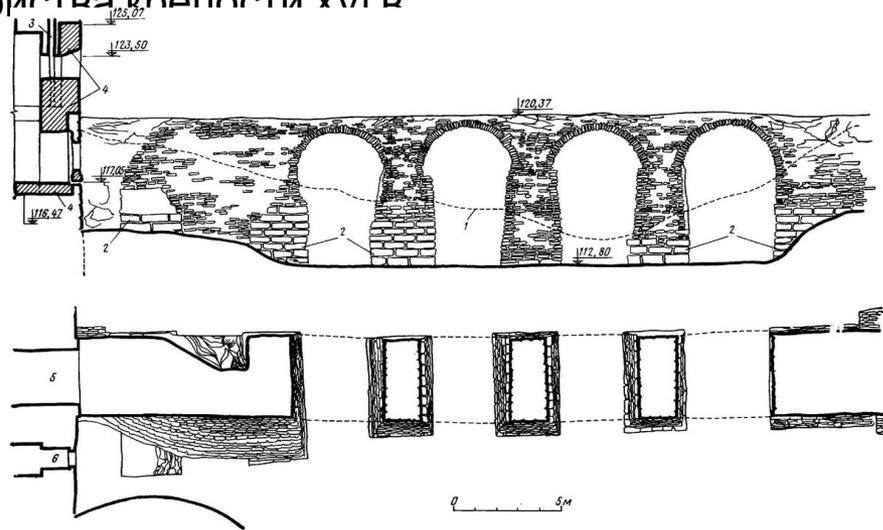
Фасад и план коста Копорской крепости по натурным исследованиям
